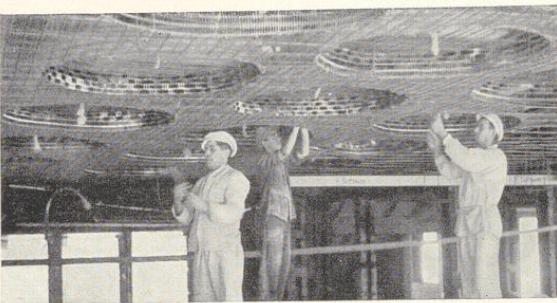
Rabitzdecke mit runden Vertiefungen für Beleuchtungskörper. Ausführung Stukkateurmeister E. Schwarz, Stuttgart-Hedelfingen
